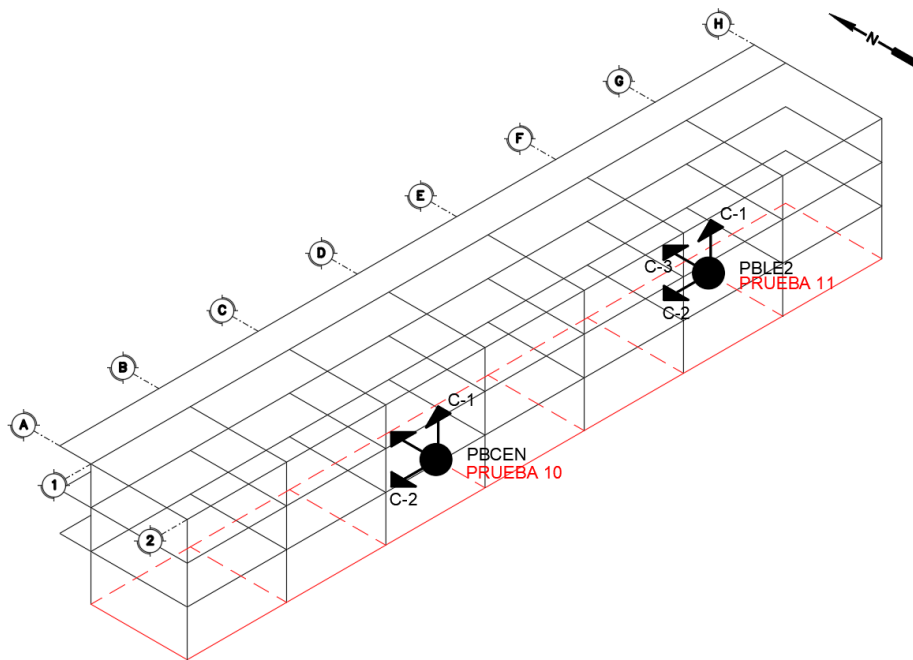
Puntos instrumentados para prueba 10 y 11 en planta baja.
